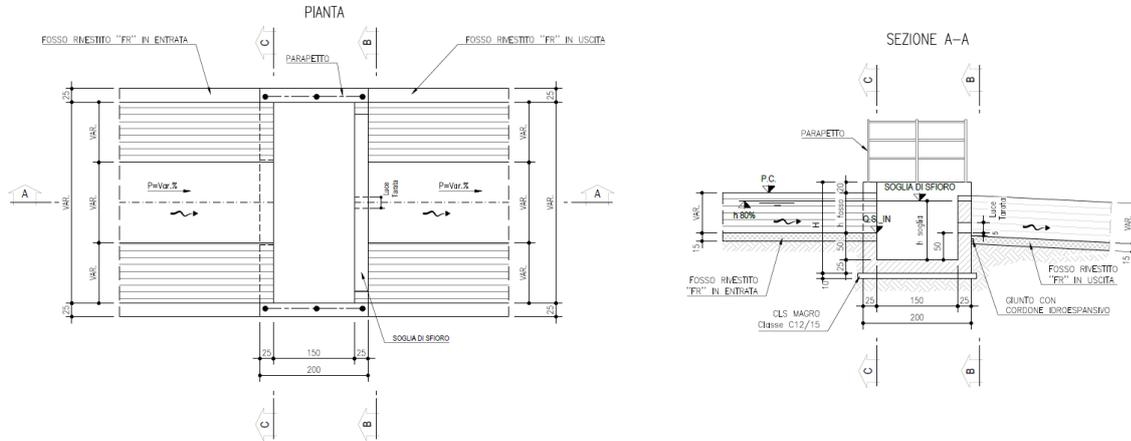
Sezione tipologica dei manufatti di regolazione tipo "MC1"
